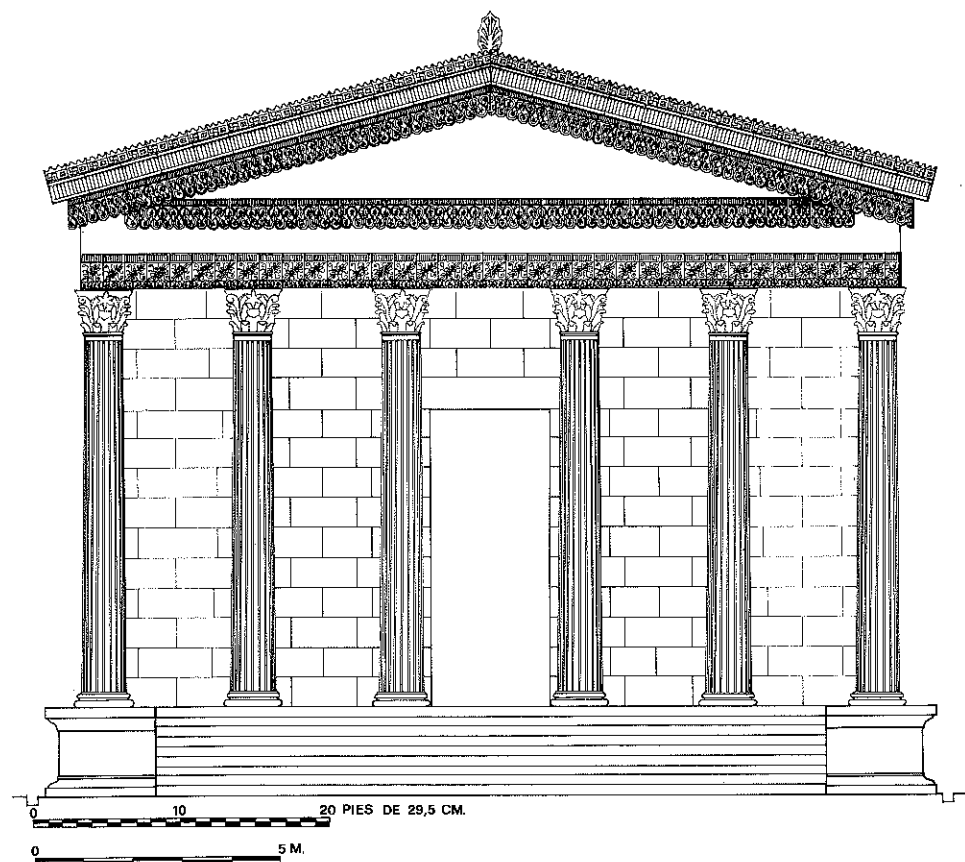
Reconstrucción del alzado frontal del templo. Escala, 1:150.
